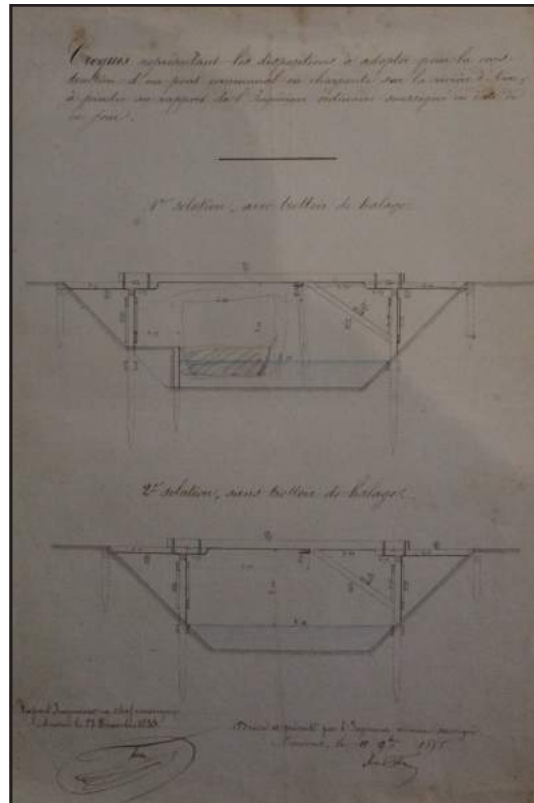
Ebauche de construction du pont de Hailles(source : 99S489/5)
